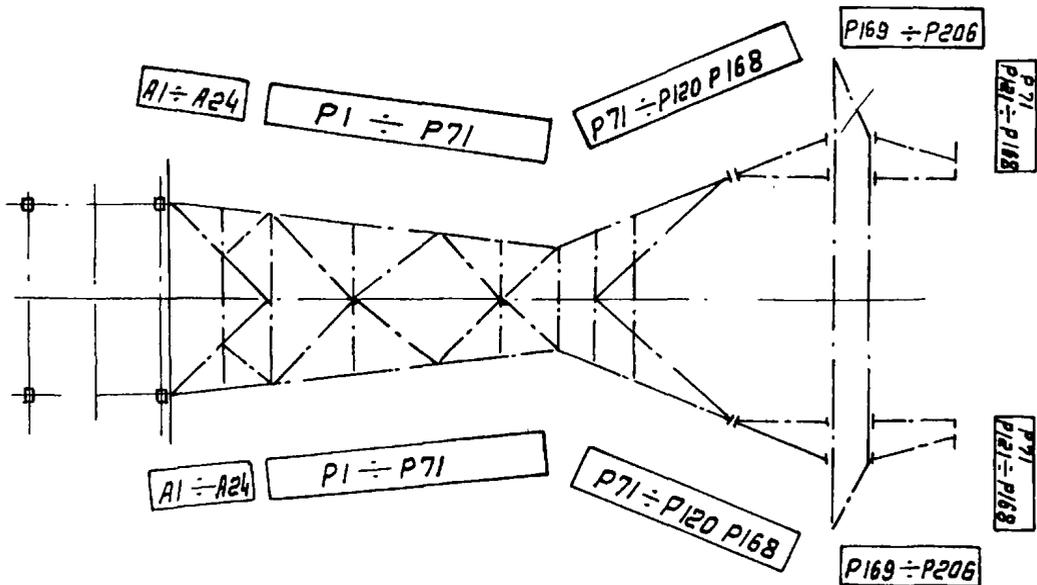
План расположения пакетов с деталями опоры P1+5 или P2+5
